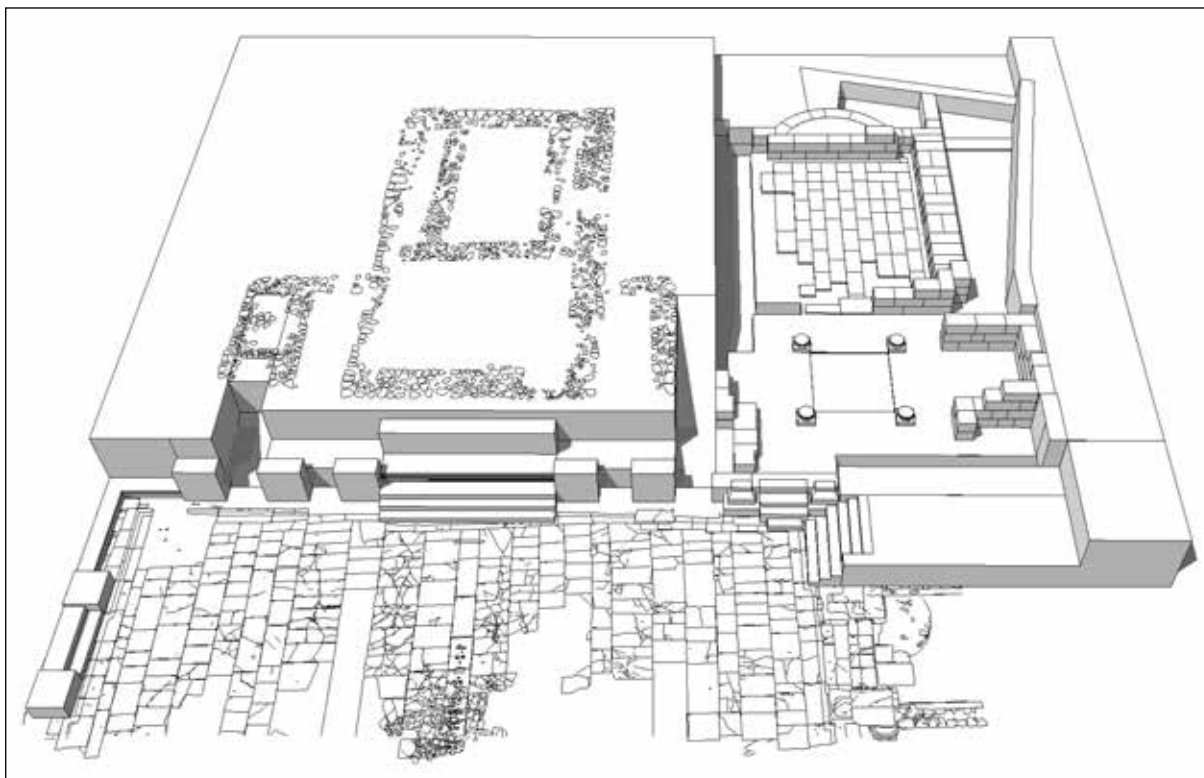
Vista estado actual de las estructuras. Modelo 3D realizado en SketchUp. Fuente: Elaboración propia.
